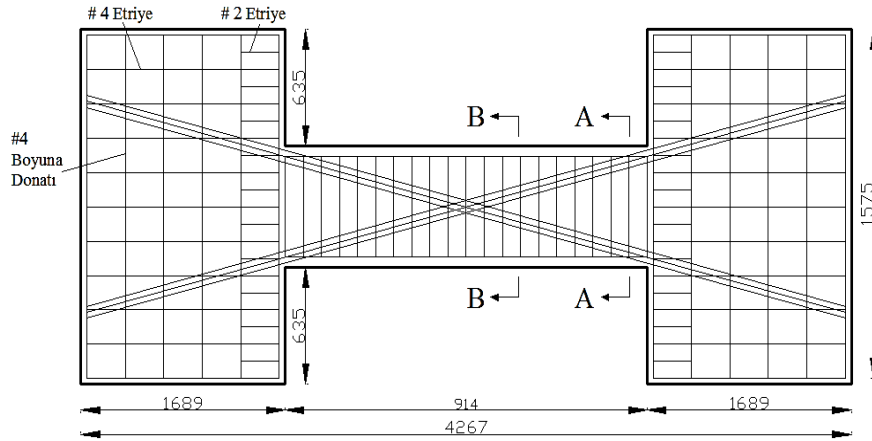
Adebar ve ark.'na ait bağ kirişi donatı detayı [104]
